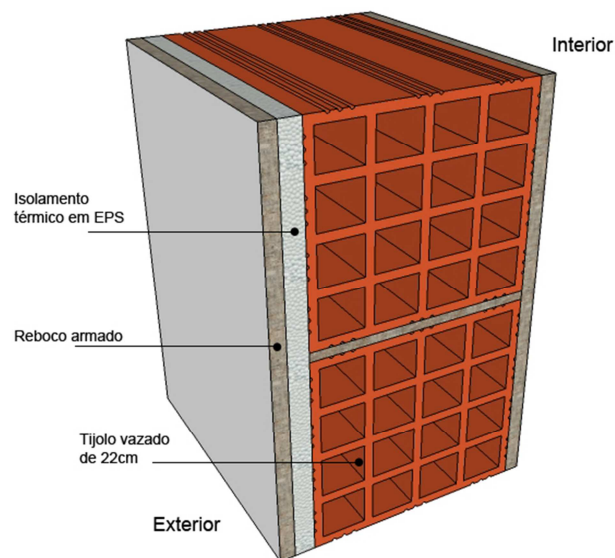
Solução construtiva em alvenaria de tijolo vazado de 22cm de espessura e isolamento térmico em EPS colocado pelo exterior
